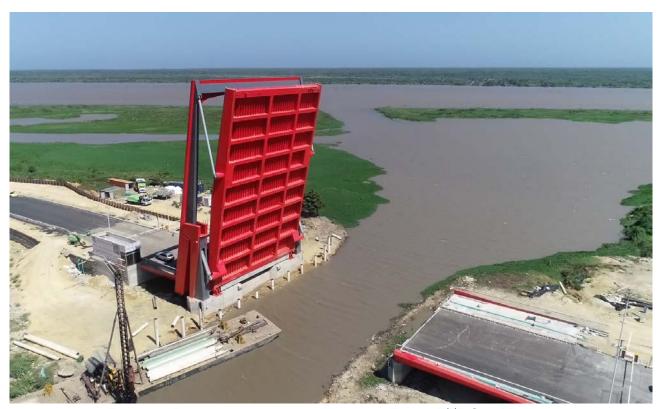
Secuencia de apertura del puente móvil durante las pruebas
